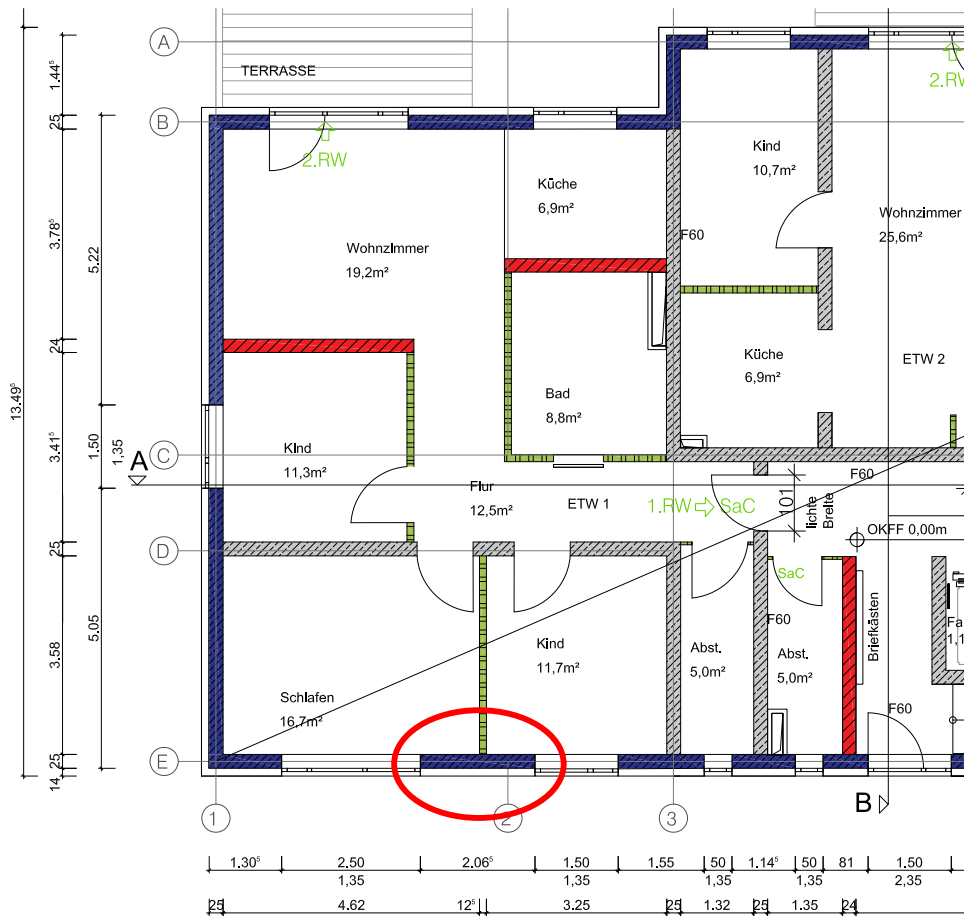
Grundriss des Erdgeschosses (grün: nichttragende Wände)
